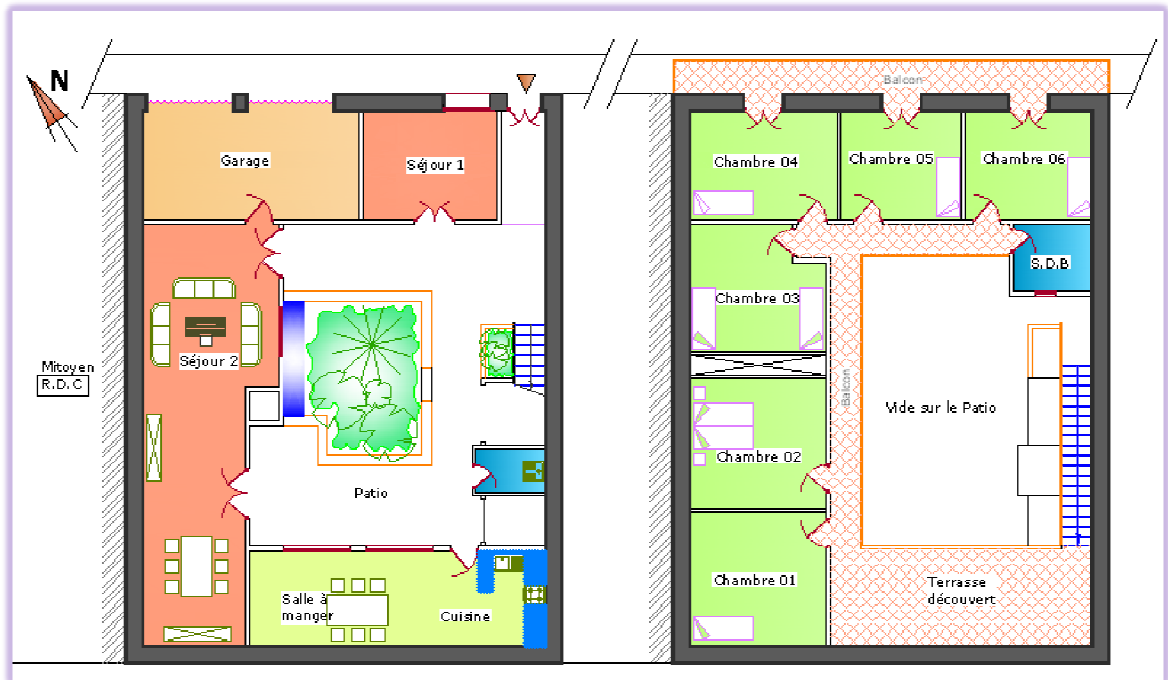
Plan R.D.C (à gauche), Plan 1^{er} Étage (à droite), (Maison N°6)
